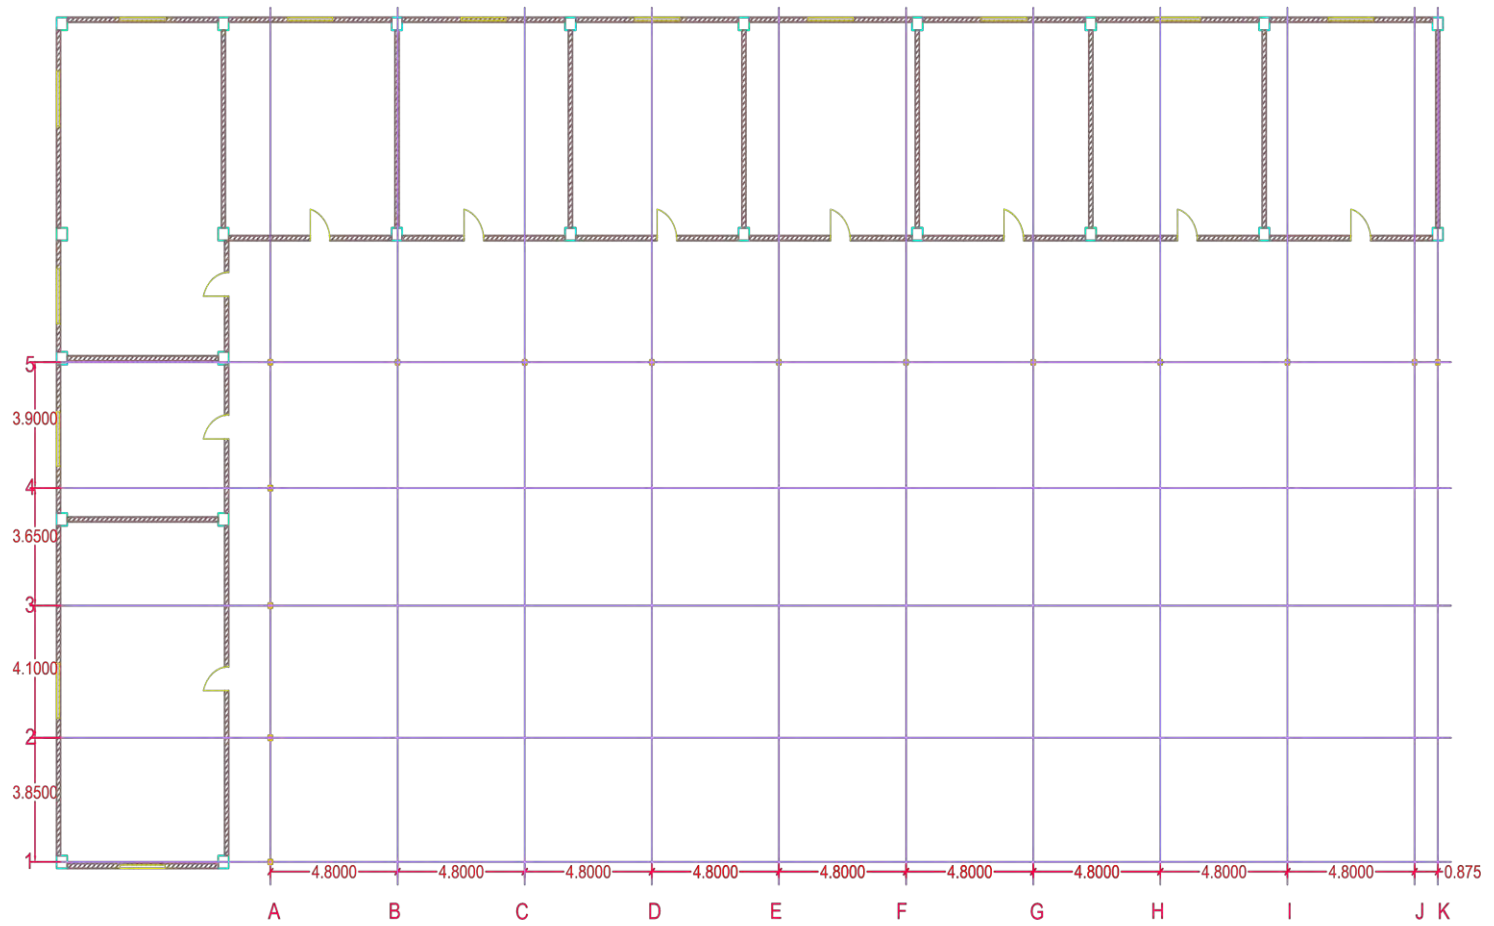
Planimetría bloque de aulas 1-grilla concreto.
